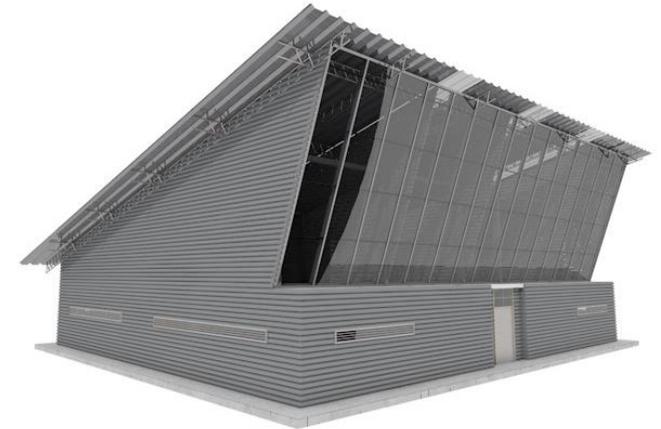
Elevación Este de Ingeniería Metalúrgica hangar. Archivo propio. 2017.
